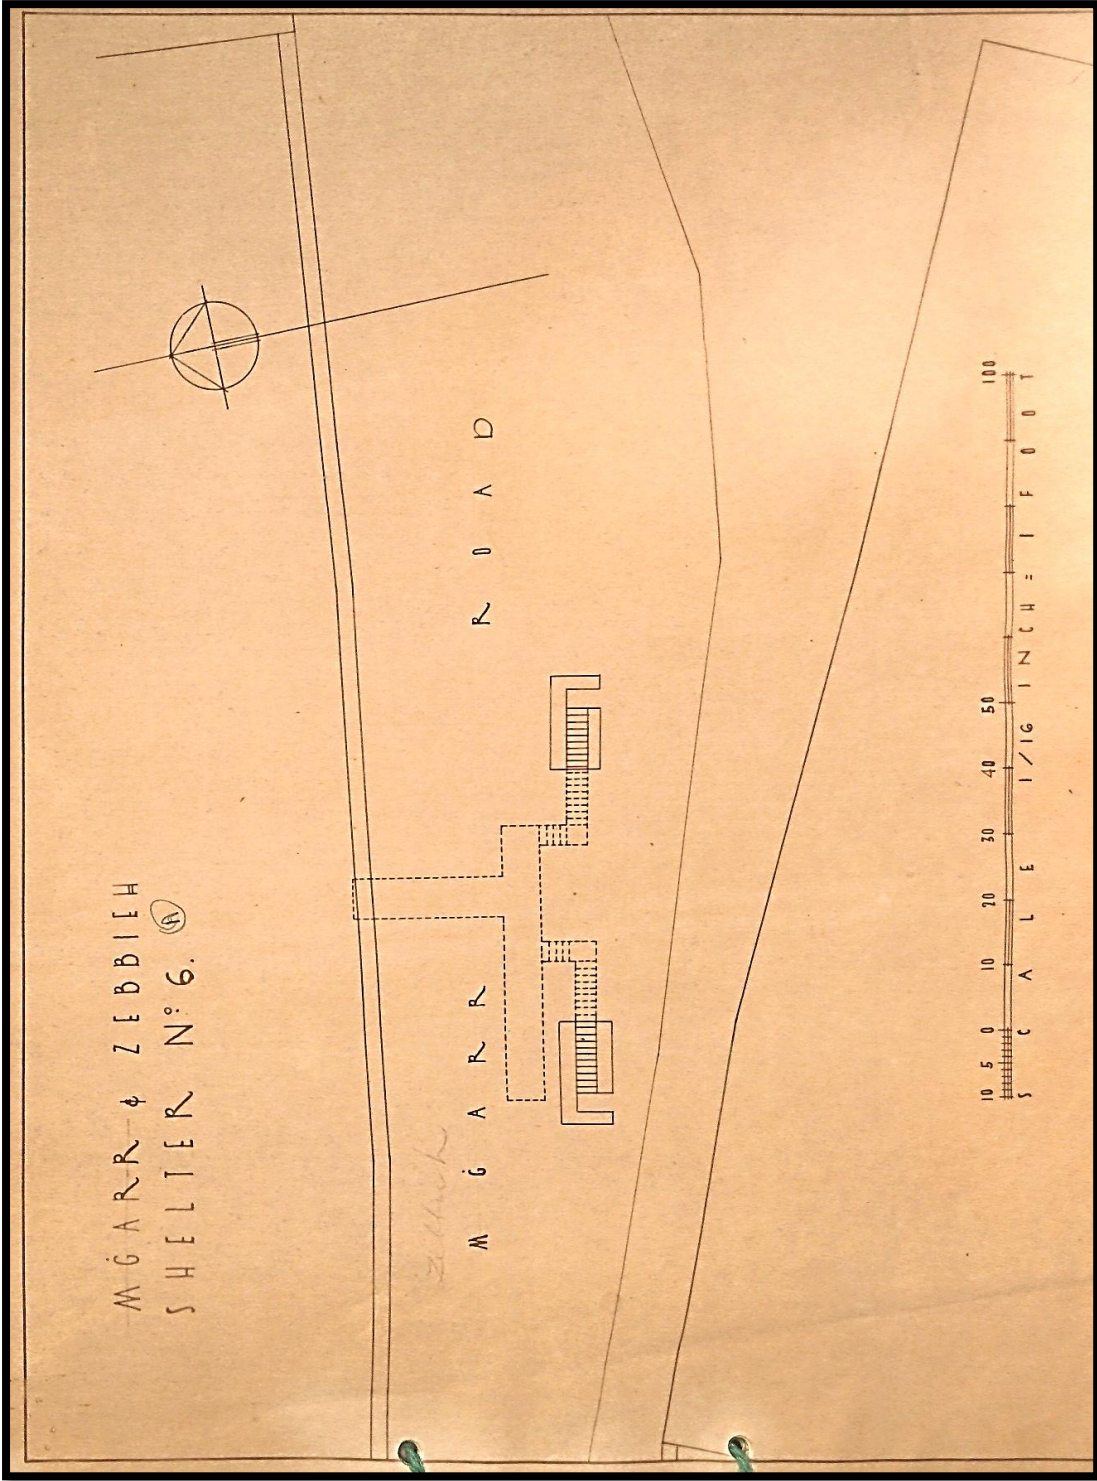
Planta do Abrigo nº 6A "Mġarr Road"
